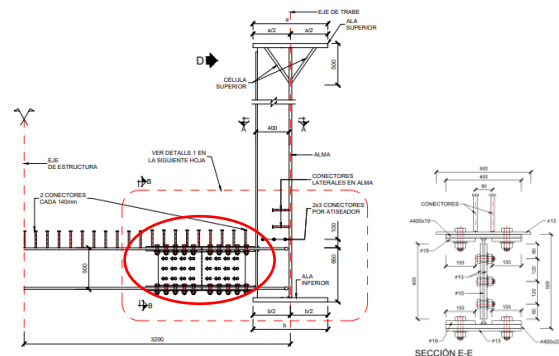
Unión atornillada marco transversal a vigas longitudinales
